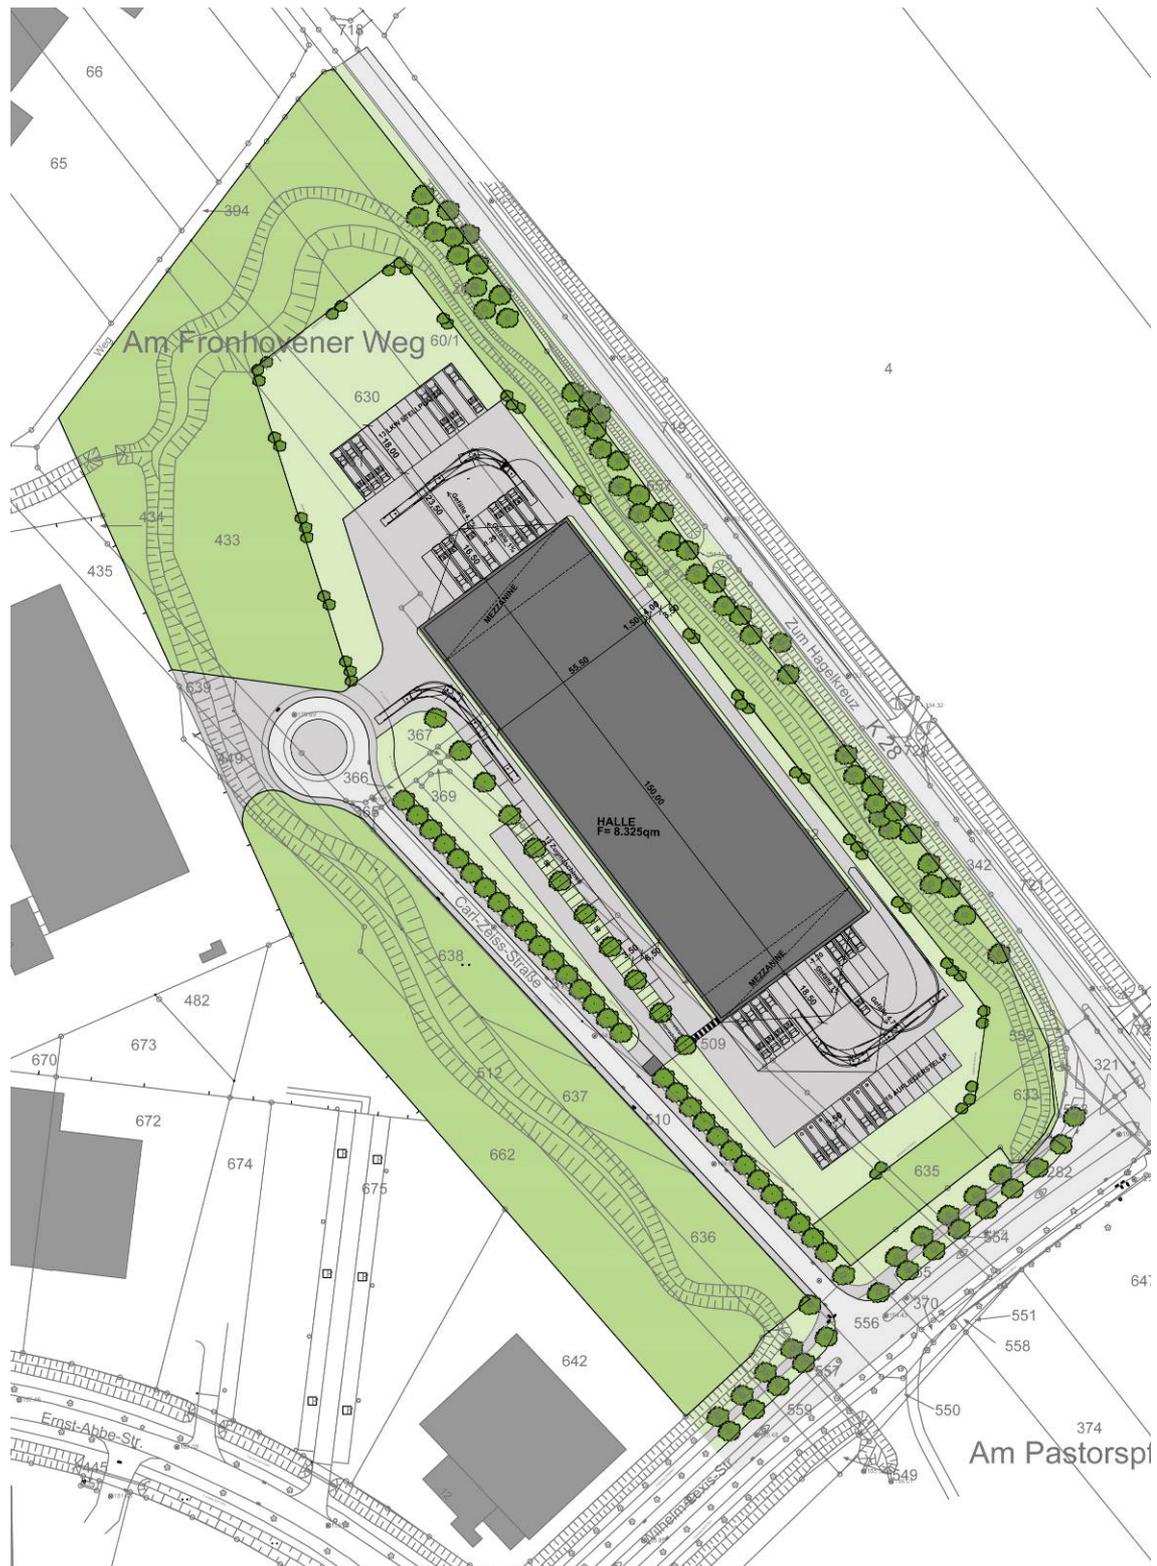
Planung Teilbereich östlich Carl-Zeiss-Straße
